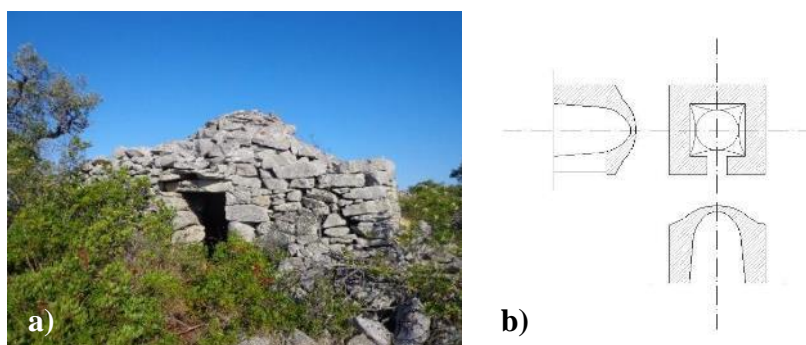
Abrigo isolado quadrilátero: a) Vista geral; b) Planta e corte
